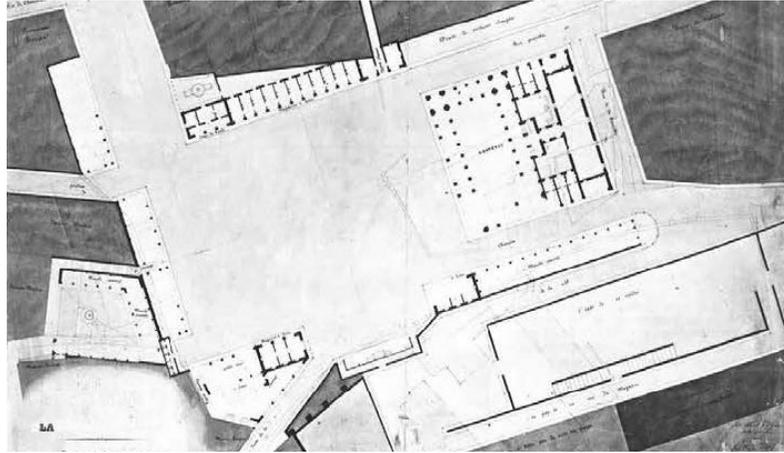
Plaza de la Riponne. Planta de la Grenette.
